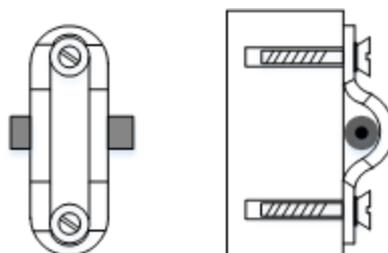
Закрепление кабеля на поверхности бетонной конструкции
